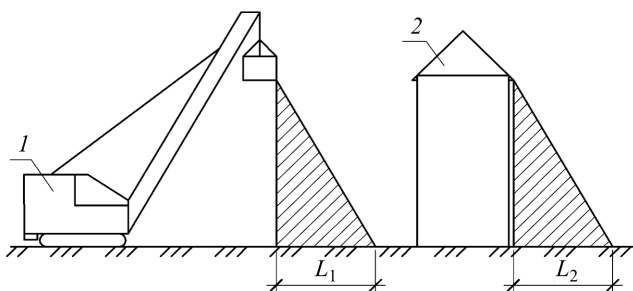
Возникновение опасных зон: 1 – гусеничный кран; 2 – реконструируемое (возводимое) здание; L_1 – граница опасной зоны вблизи мест перемещения грузов кранами; L_2 – граница опасной зоны вблизи реконструируемого (возводимого) здания
